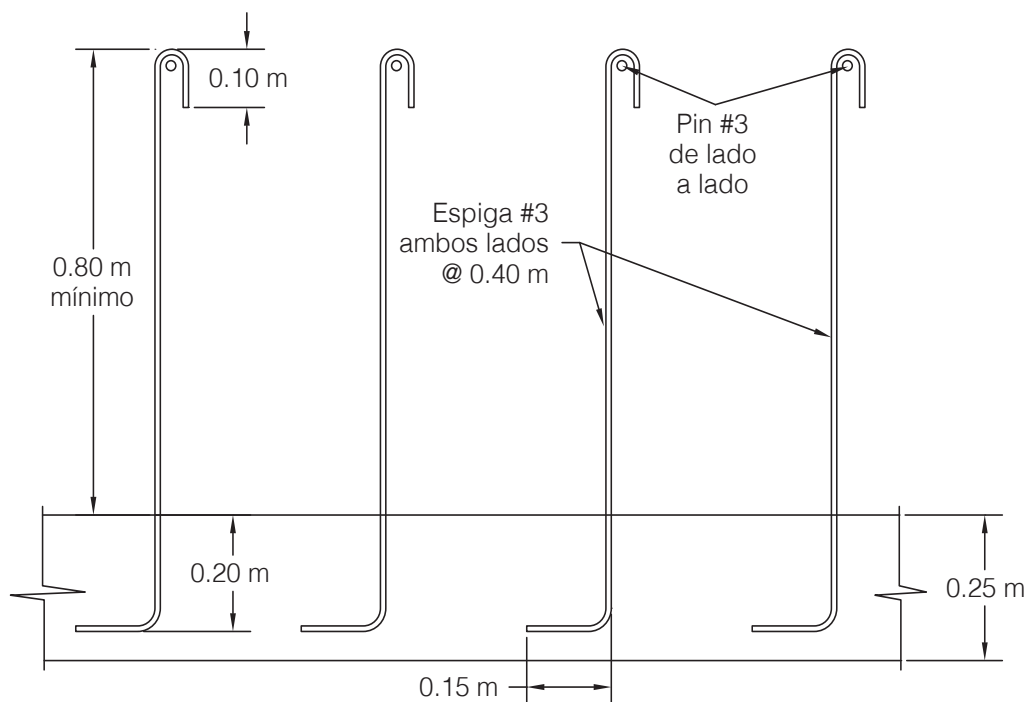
Detalle de fundación para paredes tipo emparedado con malla tridimensional y relleno de espuma expandida.
